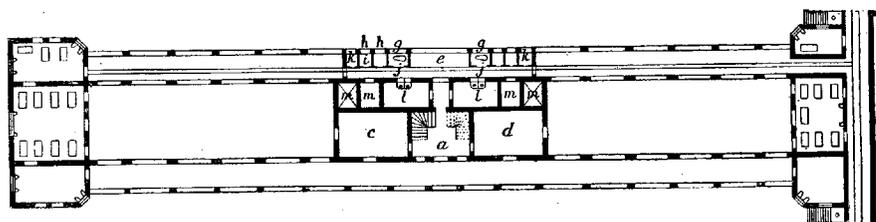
Plan du pavillon de l'hôpital de Montpellier (rez-de-chaussée).
